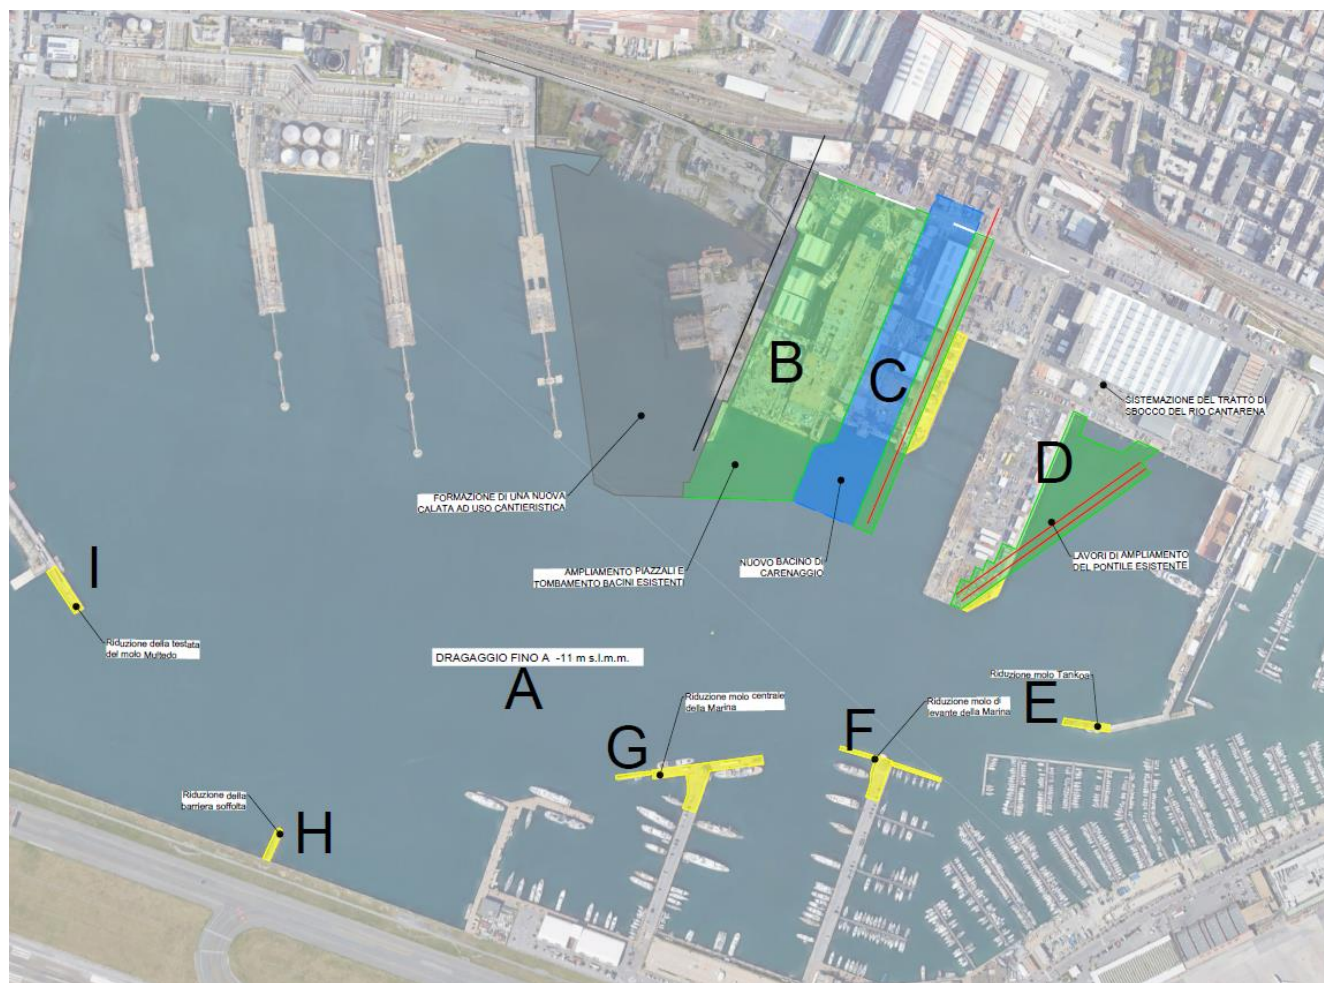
Planimetria con indicazione delle aree di intervento (opere).
